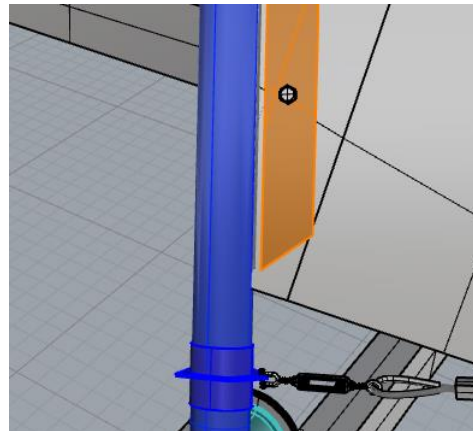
Detalle de la placa de borde externa que sujeta la membrana.
